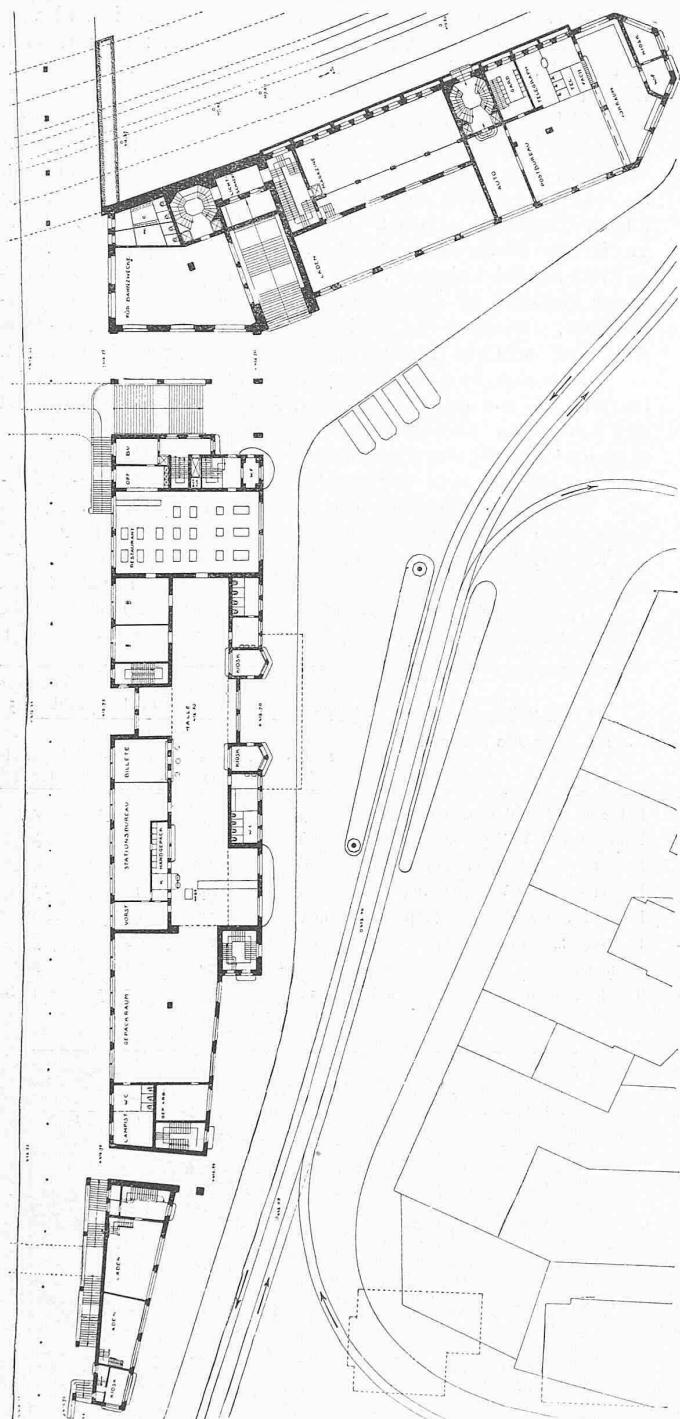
Erdgeschoss-Grundriss mit Bahnhofplatz, Maßstab 1 : 800.
